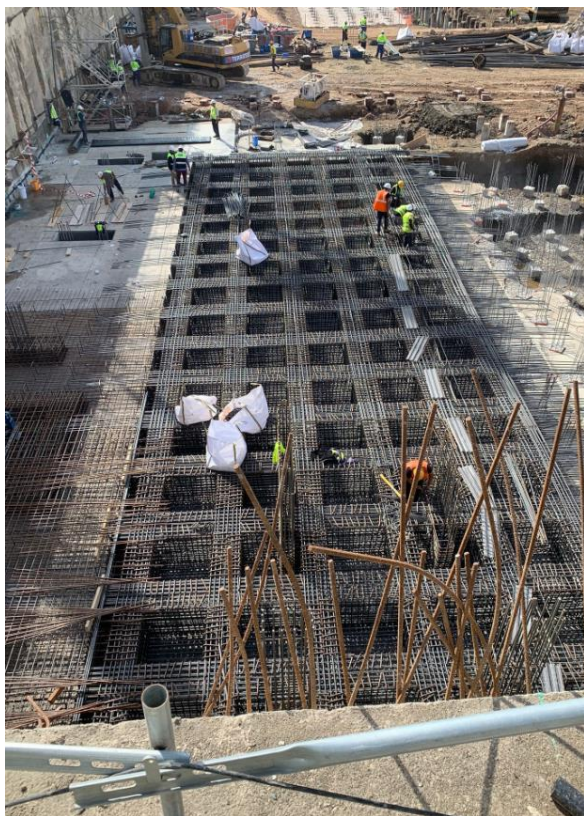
Ejecución de losa de cimentación con pilotes prefabricados.
